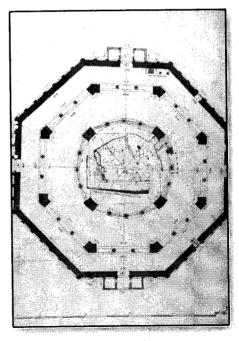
جامع مراد باشا بالموسكي (مسقط أفقي)
